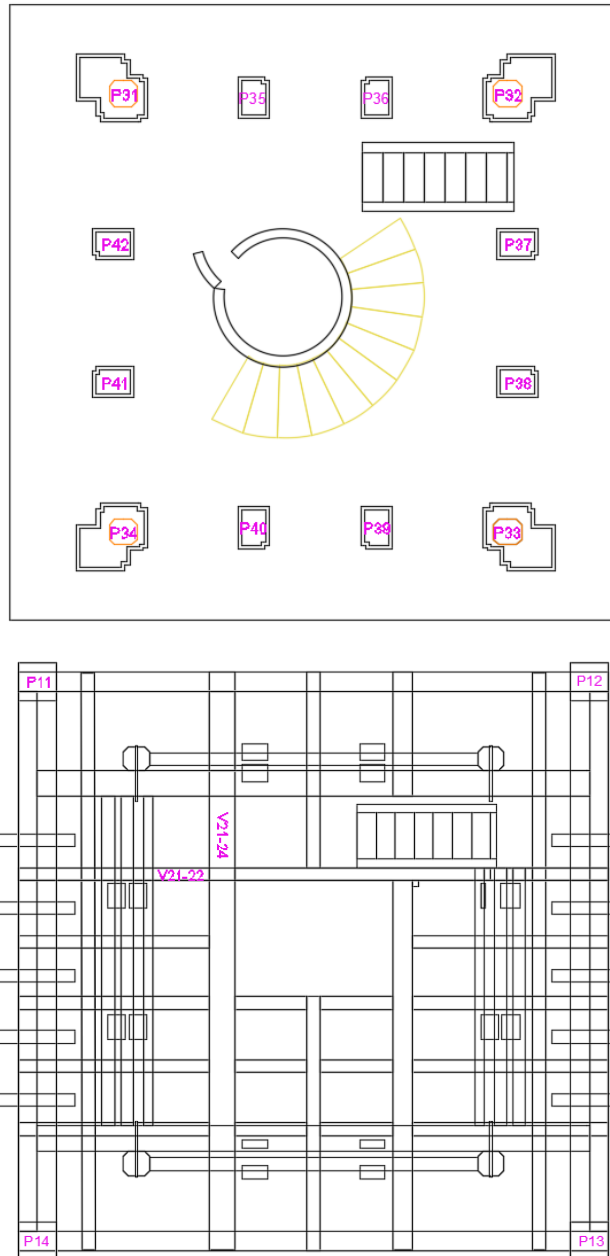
13 Planta estructura tercer nivel Torre del Reloj de Iquique
